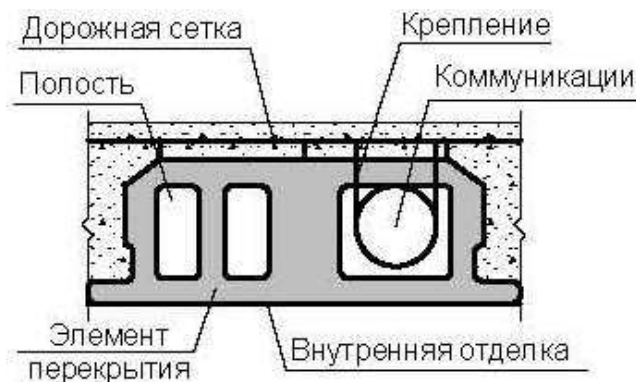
Размещение коммуникаций большого поперечного сечения в элементе опалубки перекрытия
